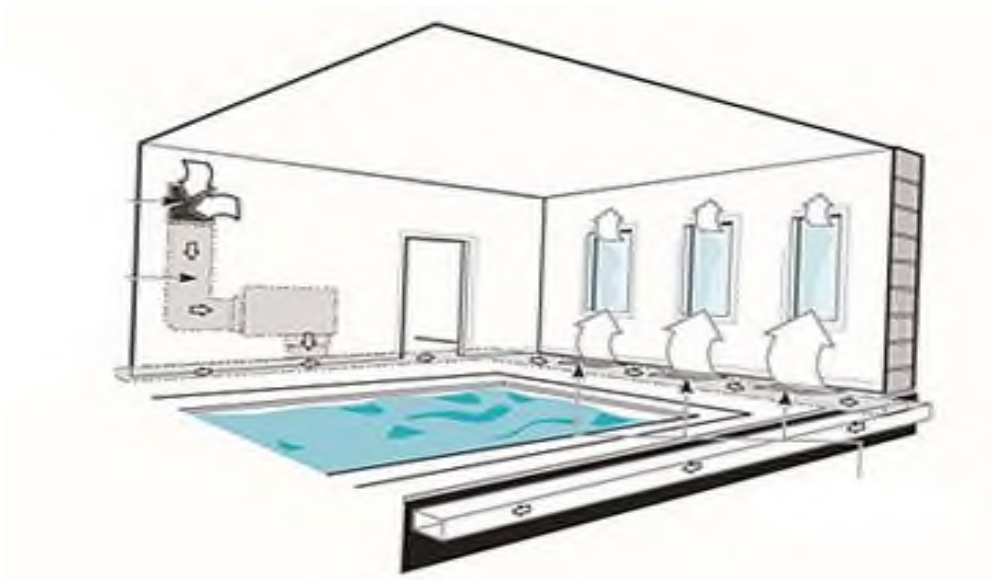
Совмещенная система воздушного отопления и вентиляции
